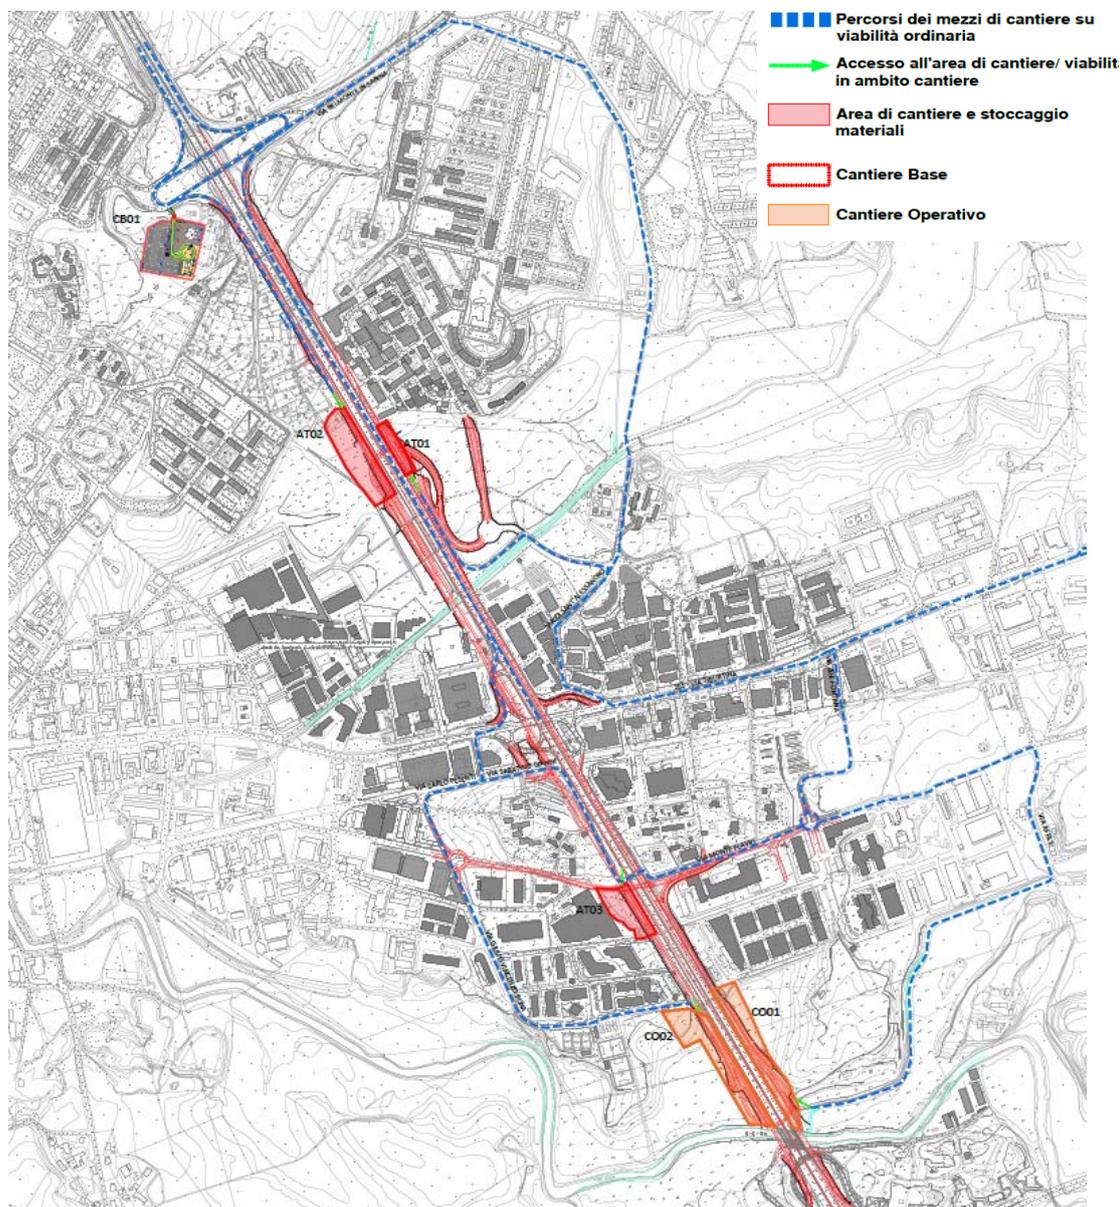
Planimetria con ubicazione aree di cantiere e viabilità
